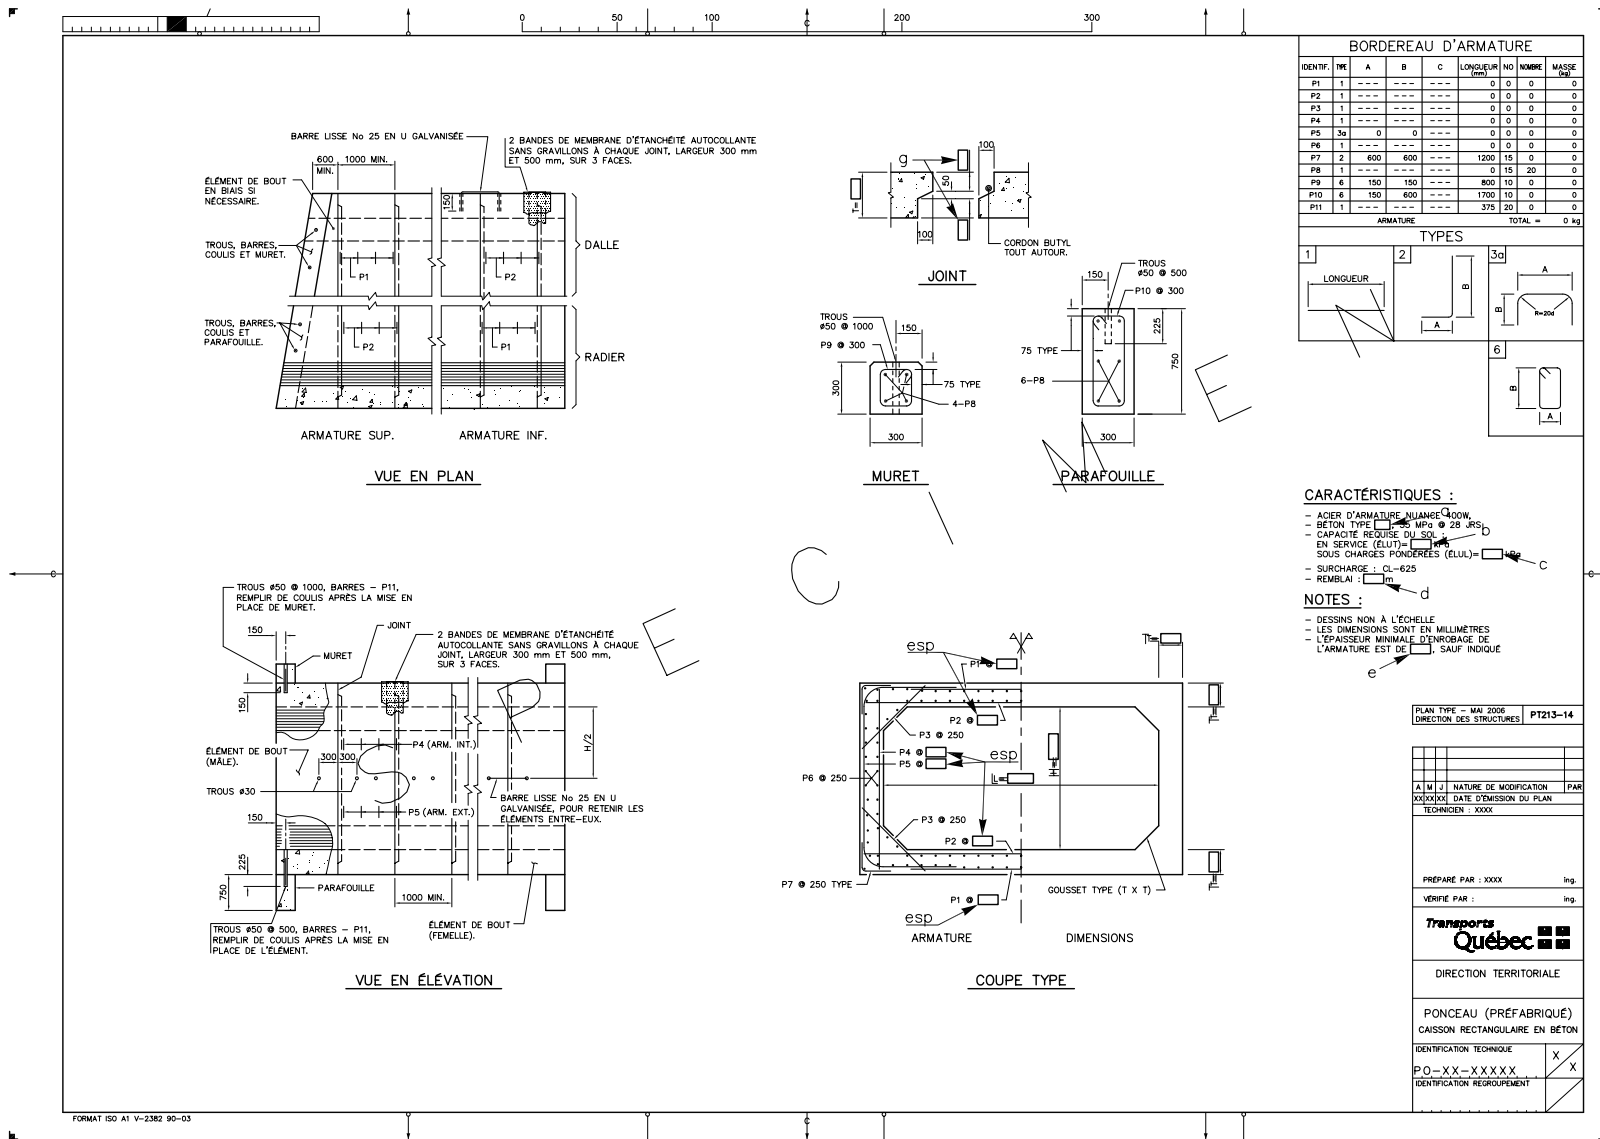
Ponceau rectangulaire en béton armé – Plan type PT213-14
